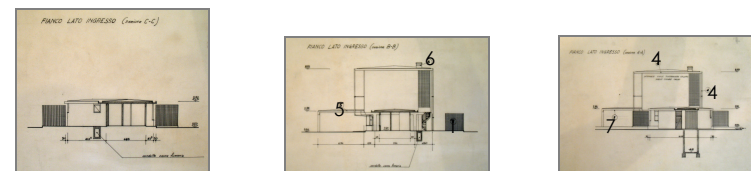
132 - 133 – fianco lato ingresso sezione CC, sezione BB e sezione AA (fonte CSAC – archivio n. 276-1, rielaborazione f.m.)
